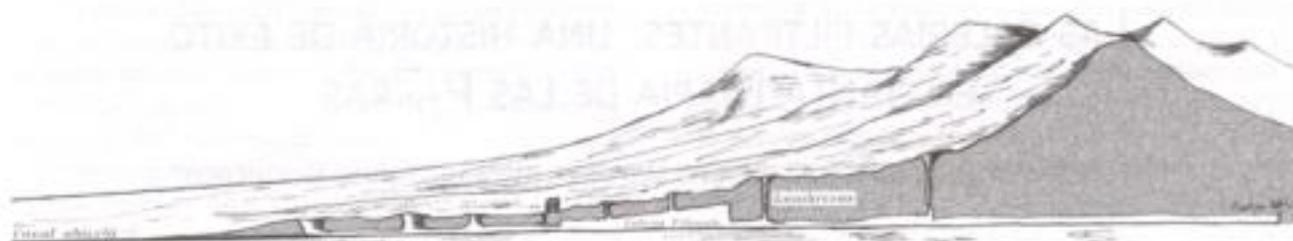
Perfil de la galería filtrante Zapata, Parras de la Fuente, Coahuila, México.
